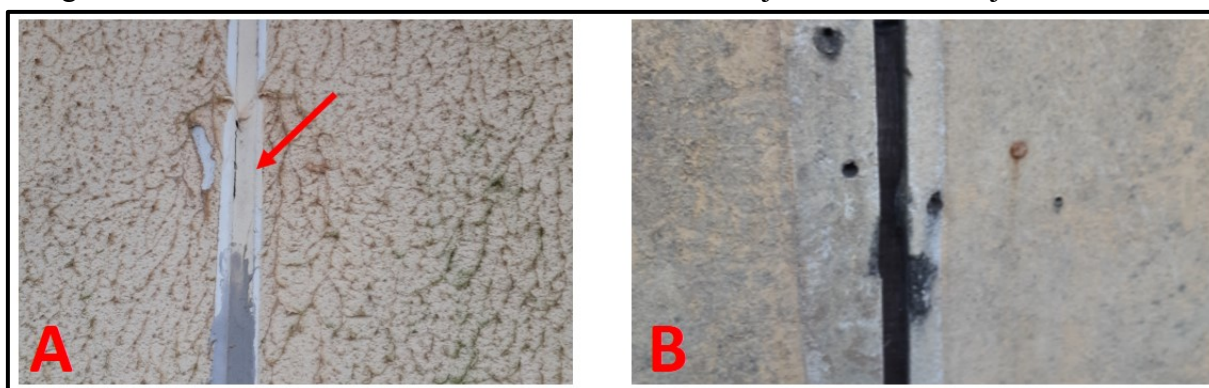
A- pilar da HIS 10 e B- um modelo de porta pilar metálico.
